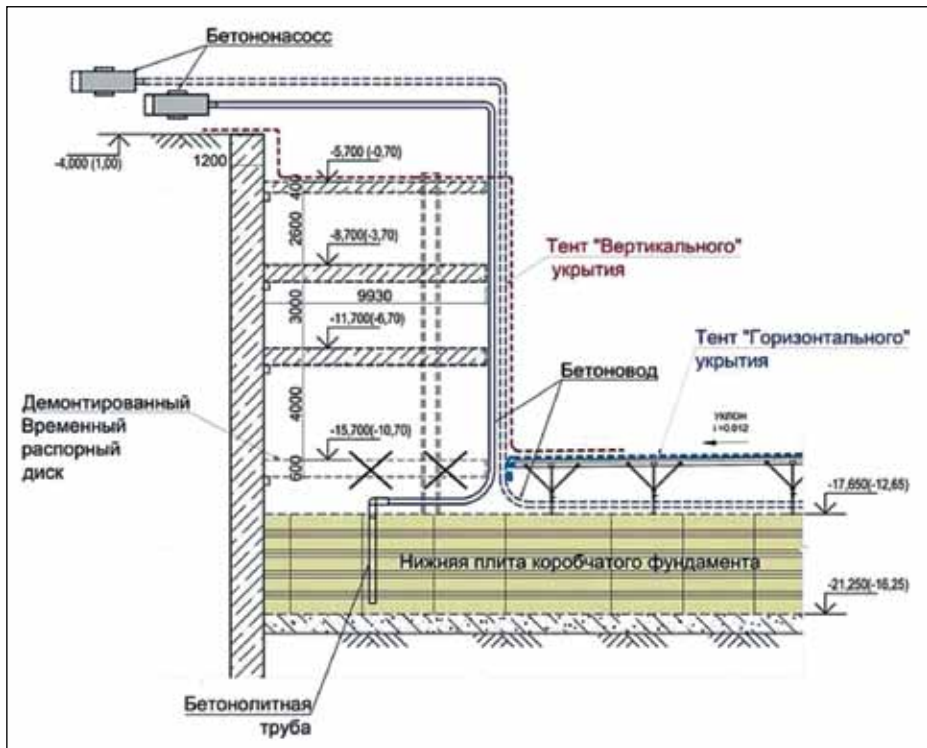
Схема укладки бетонной смеси и направление фронта бетонирования
